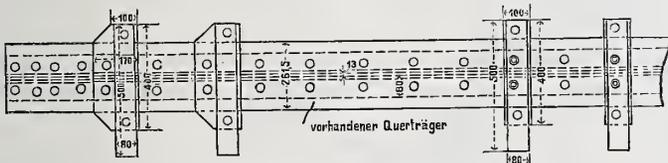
Auflager der neuen Längsträger auf den vorhandenen Querträgern (Grundriss zu Abb. 3).
